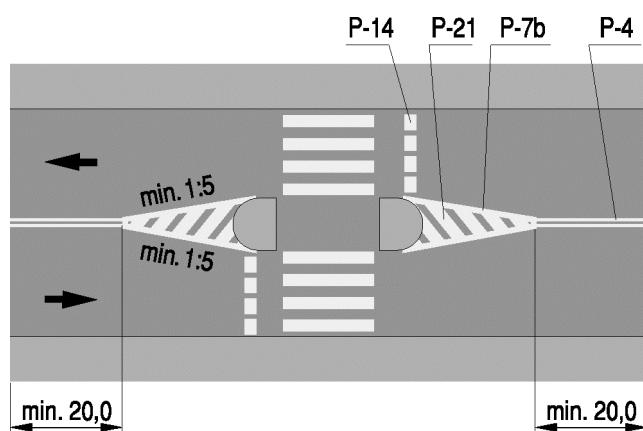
Sposób wyznaczenia poszerzonego przejścia dla pieszych przy przystanku tramwajowym
